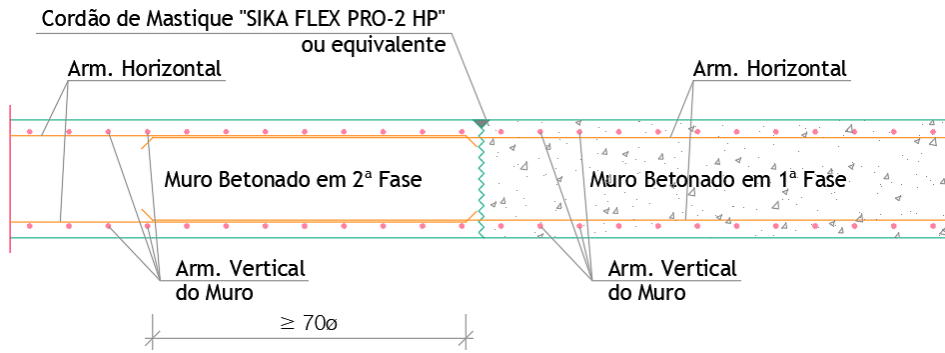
Pormenor Junta de construção em Muros de Suporte (Projeto de estruturas).
